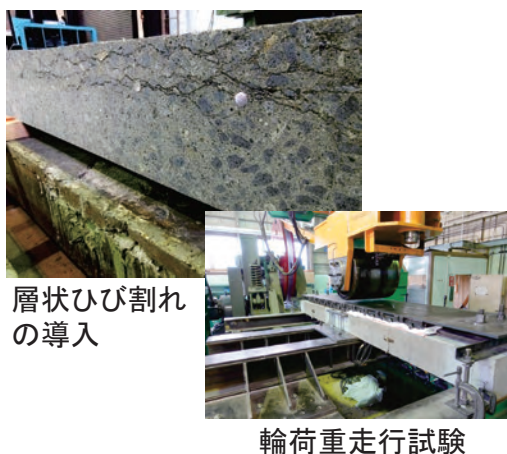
層状ひび割れを模擬したRC床版の輪荷重走行試験
